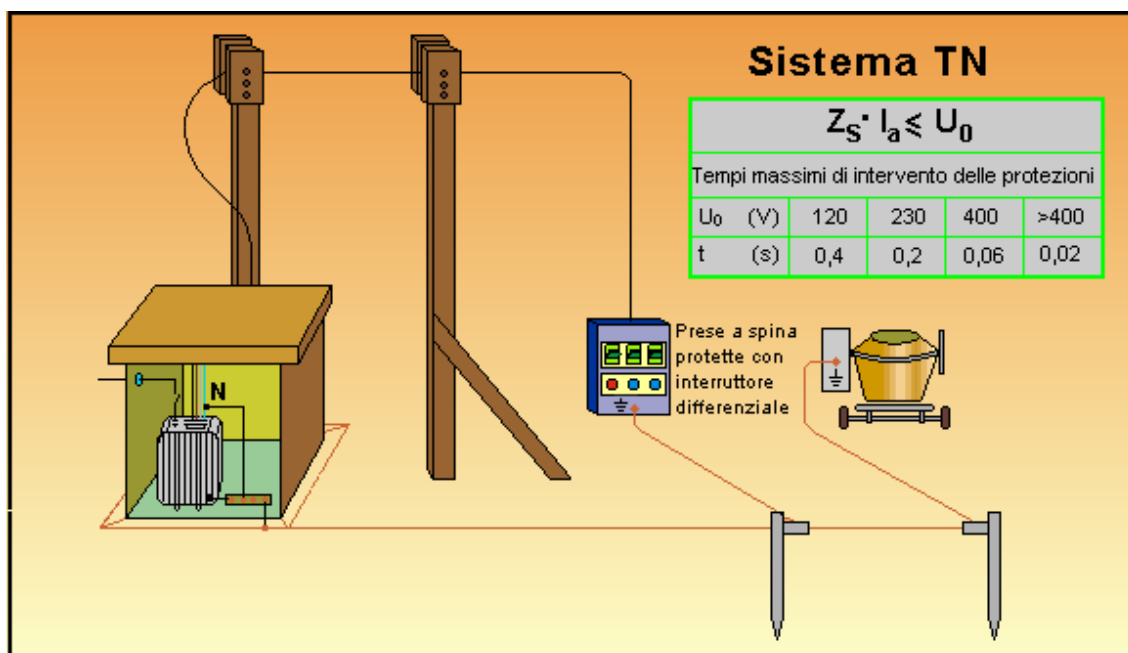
Alimentazione da propria cabina di trasformazione con sistema TN
